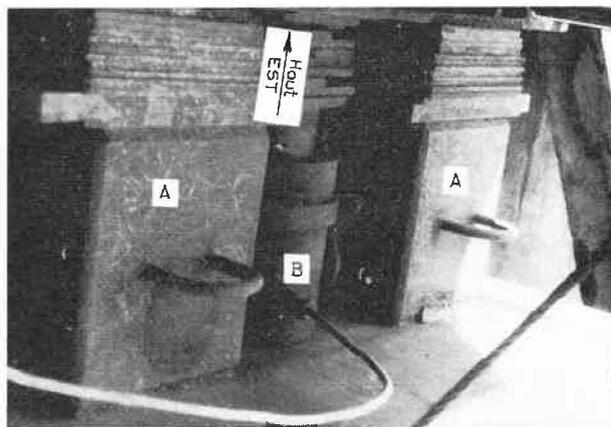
Calages placés à la partie basse du plan incliné de la fondation pour maintenir le poussard. On aperçoit entre les 2 calages le vérin de 100 t installé pour faire remonter le pied du poussard.
